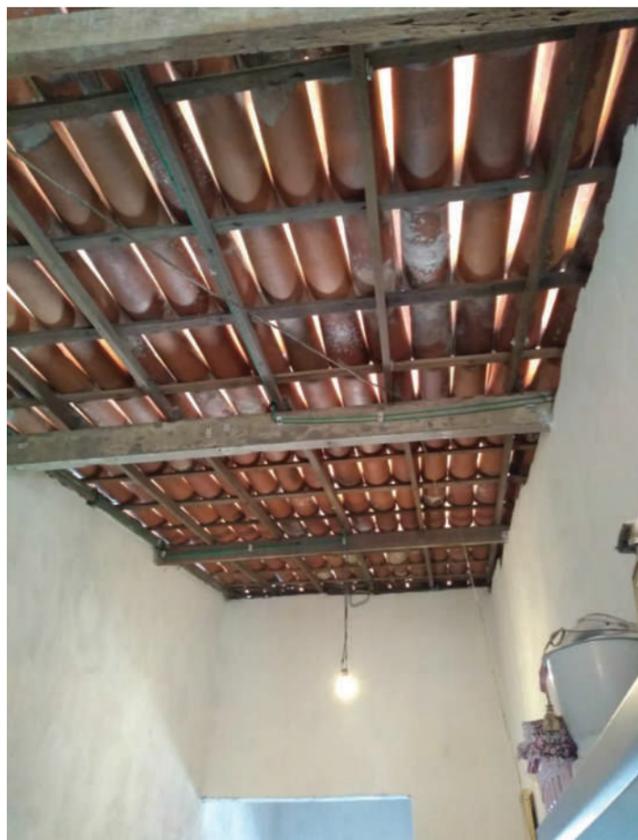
Telha aparente, instalações junto à estrutura da coberta, casa rebocada com cal.
